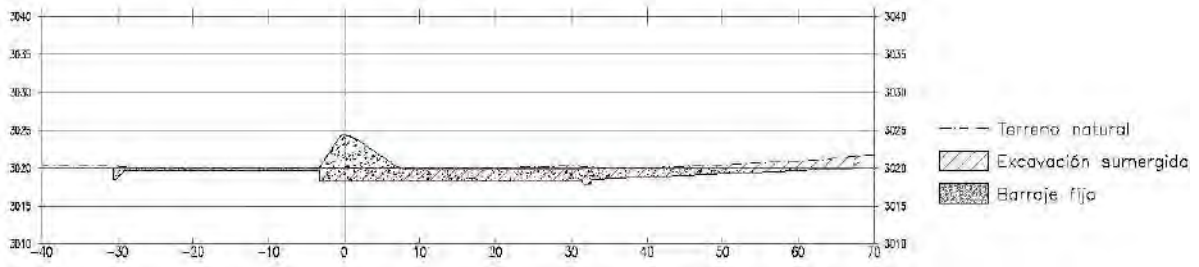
Sección típica de excavación en barrage fijo. Fuente: Elaboración propia.
